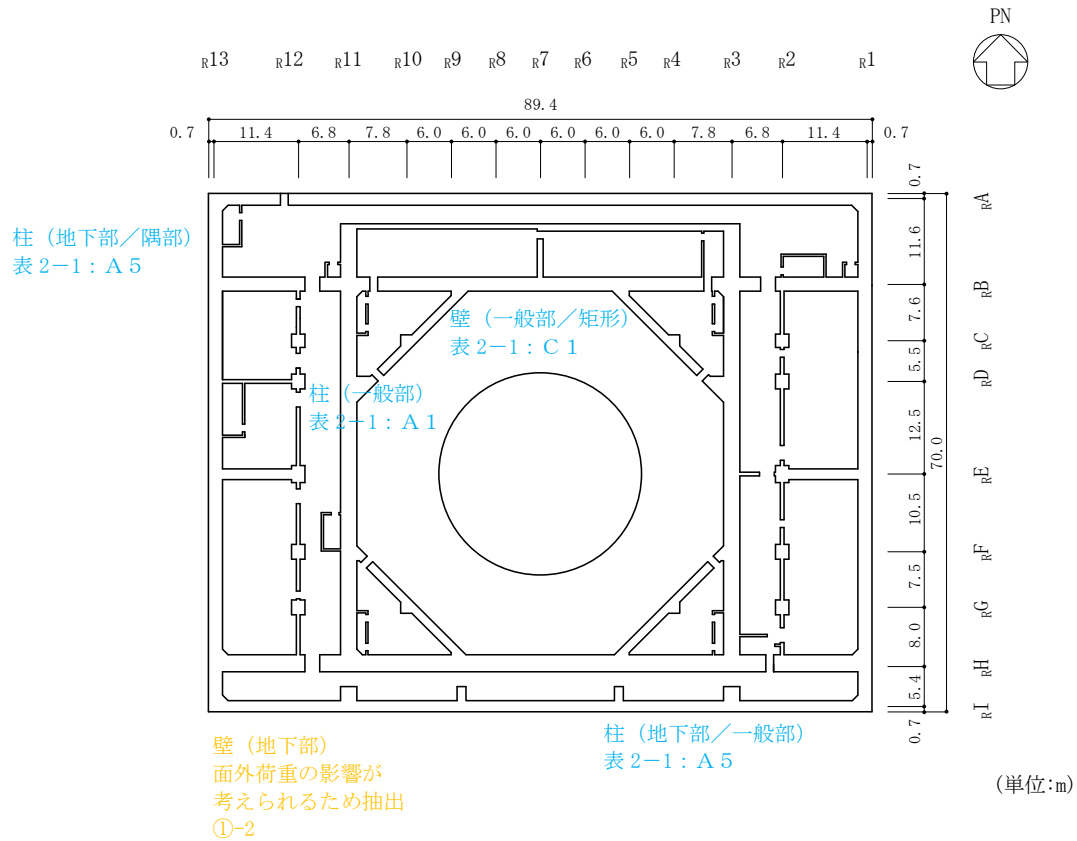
(1) 原子炉建物の概略平面図 (EL 1.3m*)
